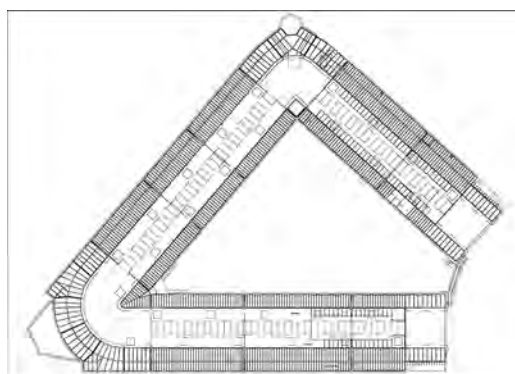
Planta del mercado. Se pueden ver los 10 bloques en que está dividido el edificio. (Dibujo de los autores).
